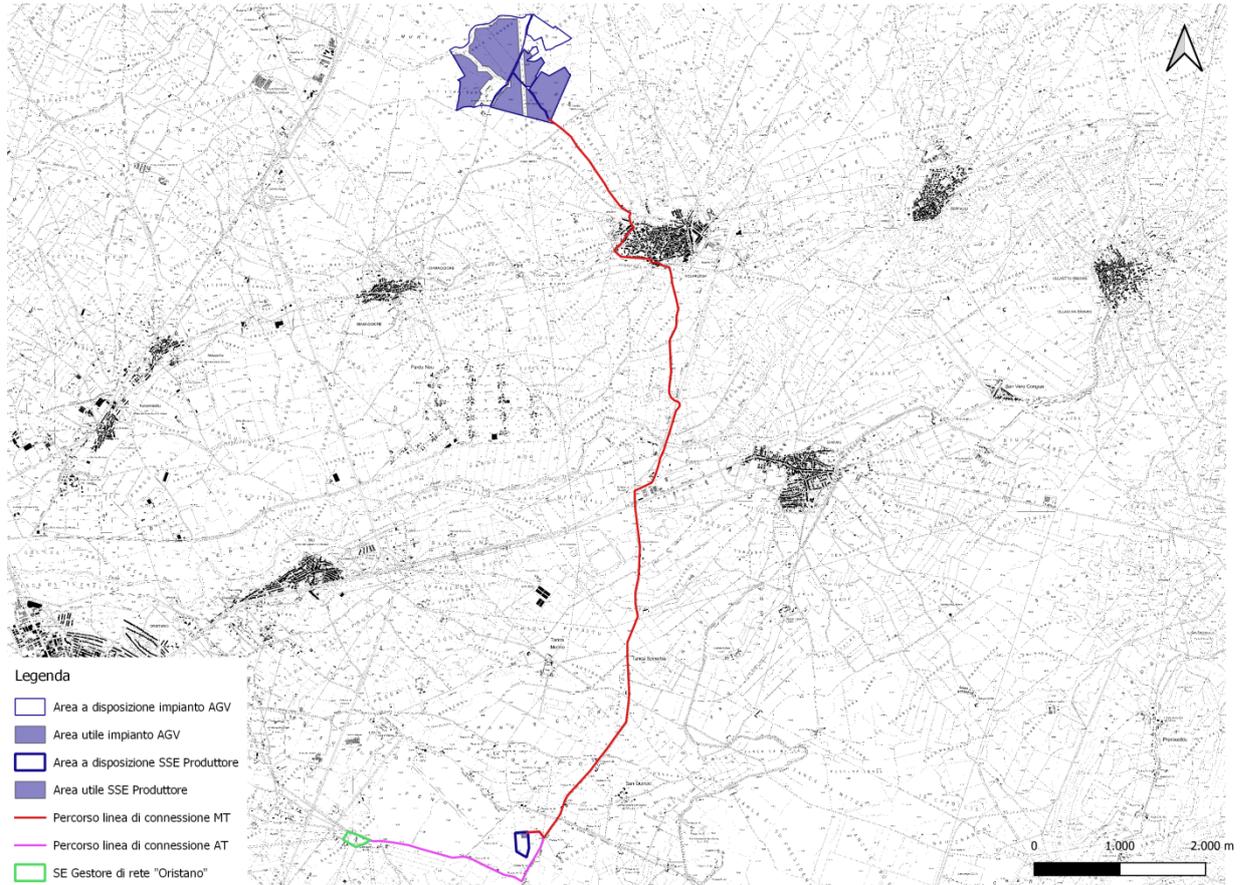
Planimetria con indicazione impianto AGV + linee di connessione + SSE Produttore su CTR.
